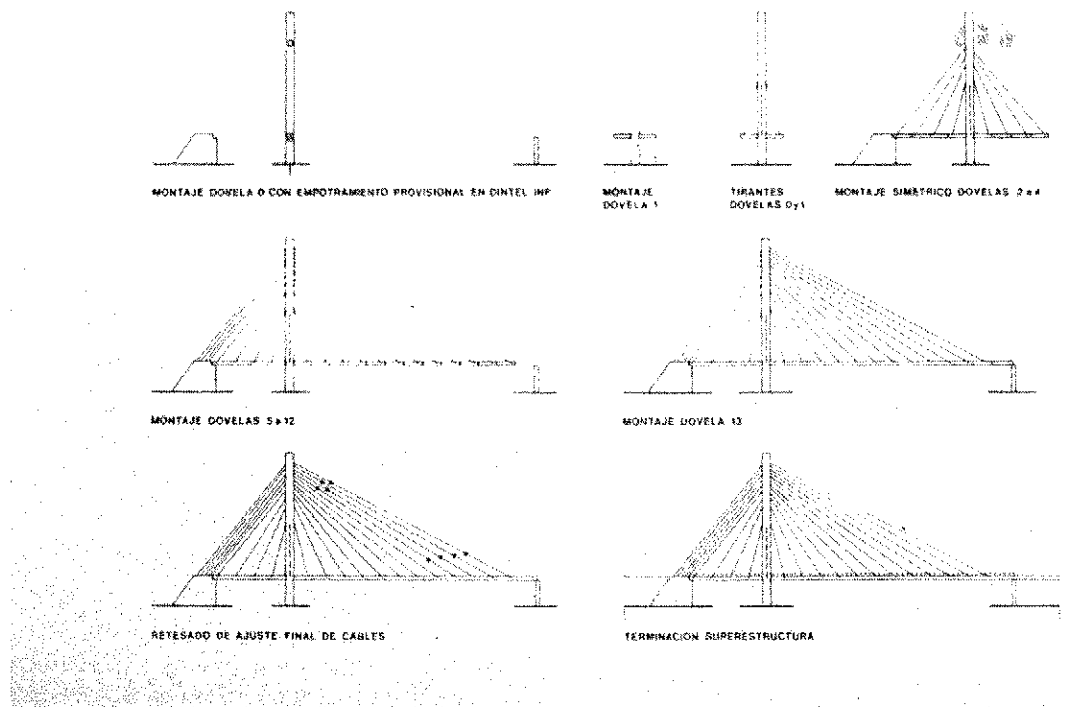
Puente atirantado con doble plano de cables. Alzado. Proceso de construcción.
